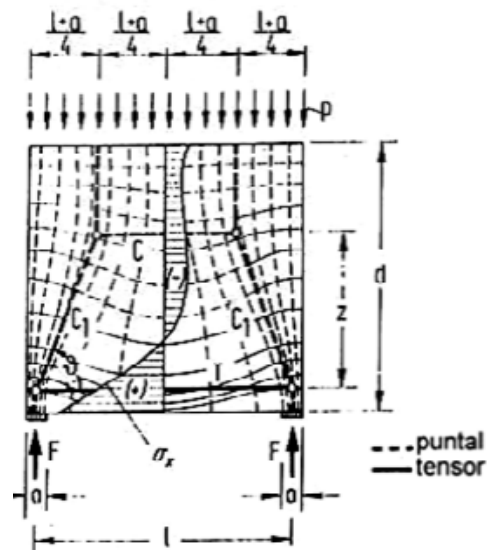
Distribución de esfuerzos. Fuente: (*America Concrete Institute, 2002*).
